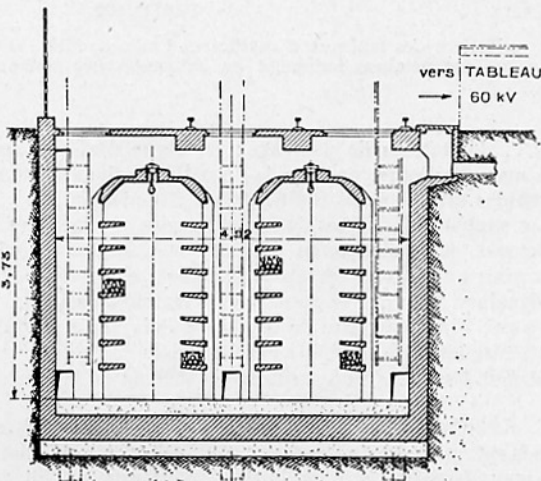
Coupe de la galerie des câbles à 60 kV.
